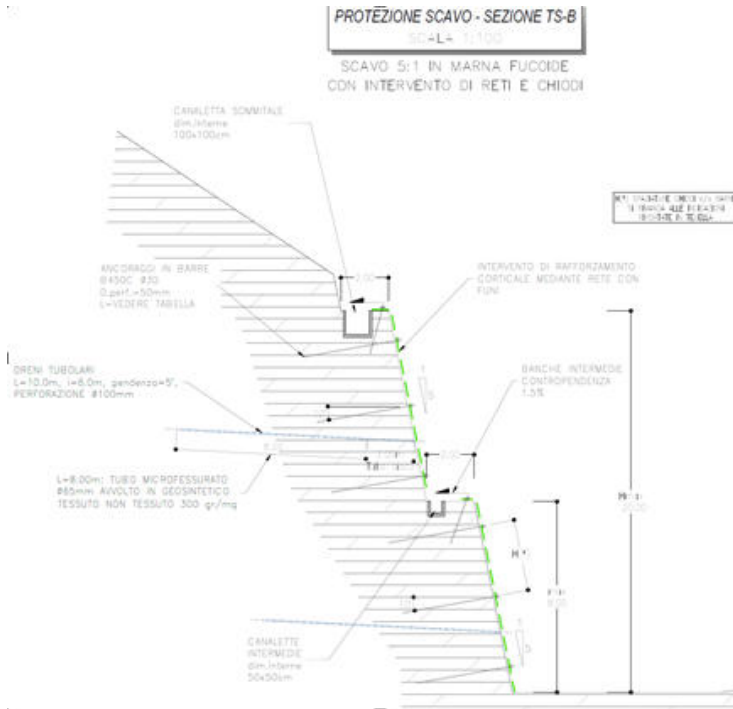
Sezione tipologica trincea e intervento di protezione scavi TS-B.
